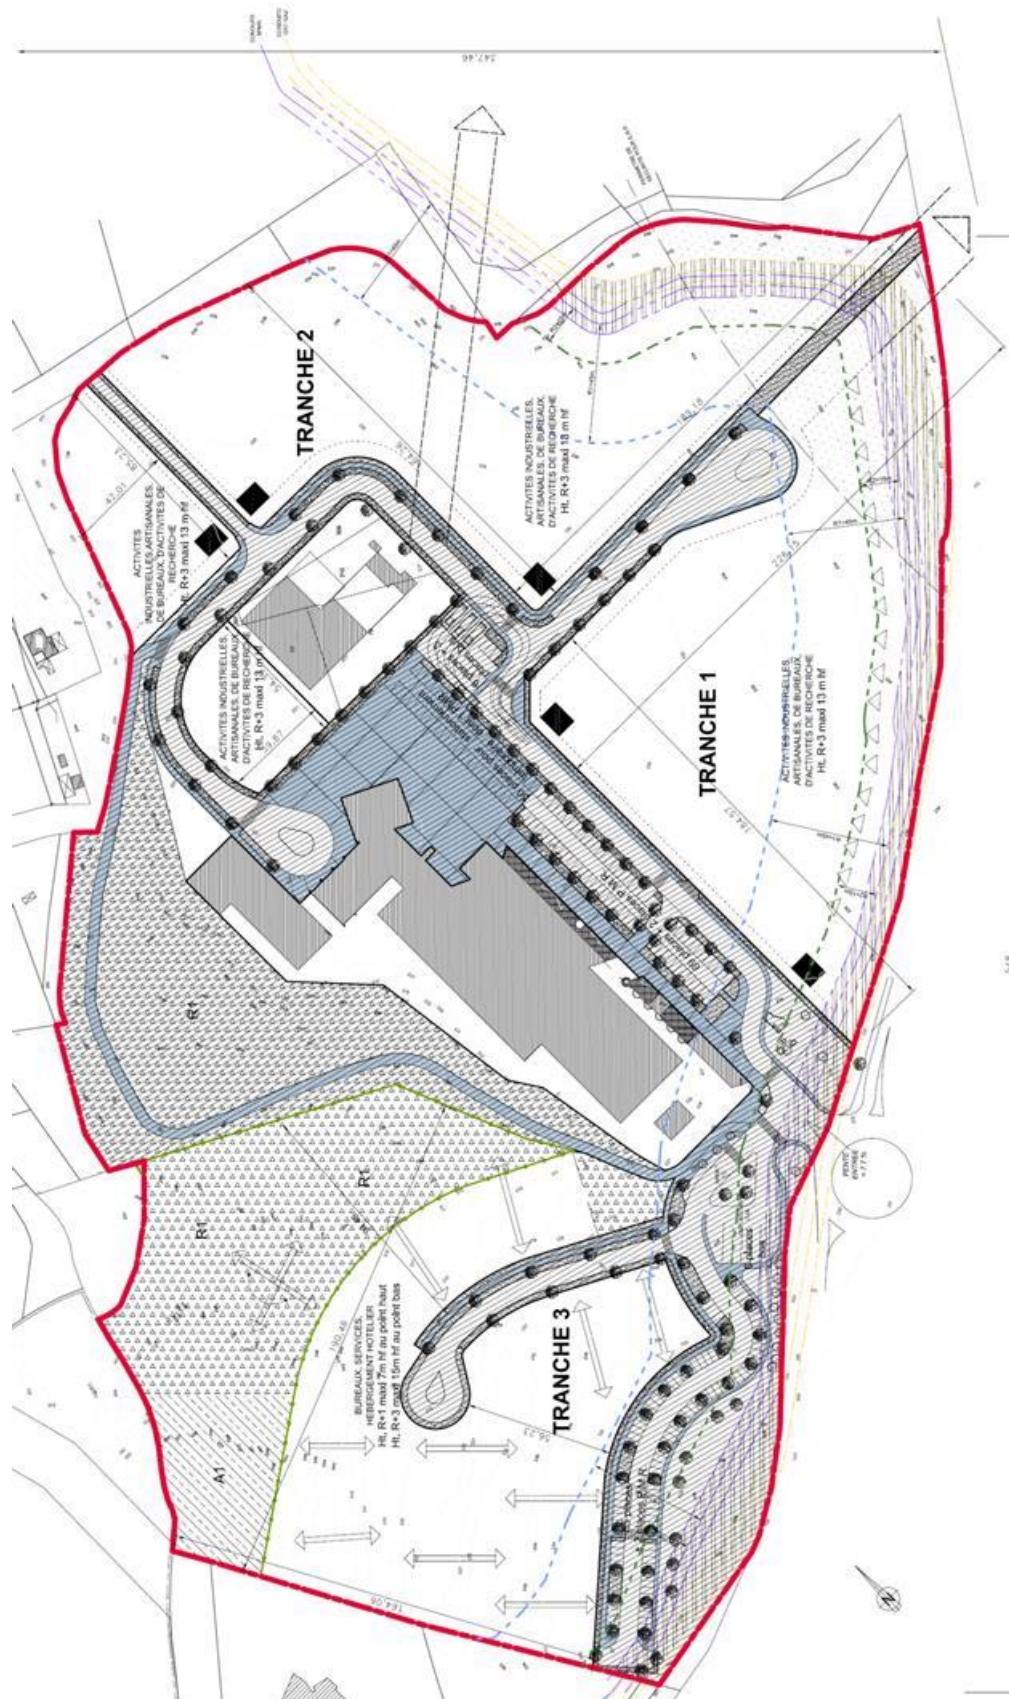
Plan masse de la ZA Morandat et des tranches d'aménagement
